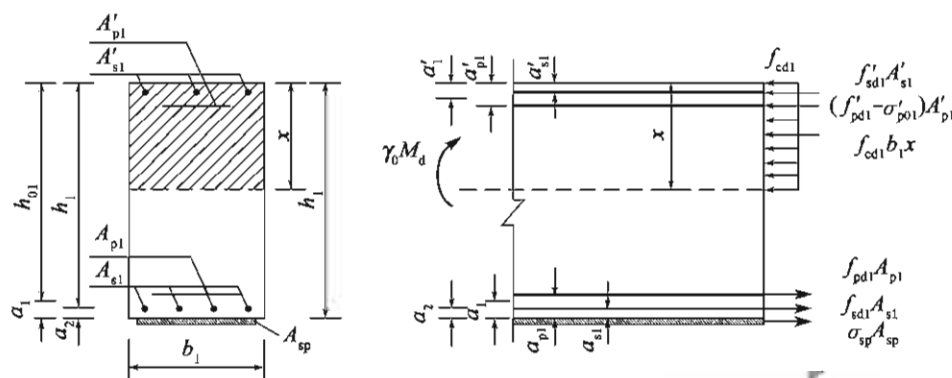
混凝土受弯构件受拉侧粘贴钢板加固正截面抗弯承载力计算
